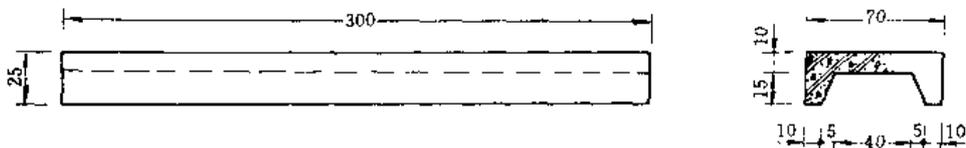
屋面槽形板截面尺寸图 (单位: cm)
